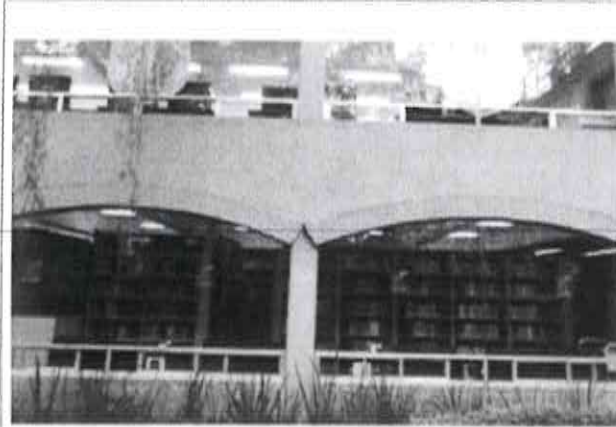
Fisuras en aplanados de muros ponientes
